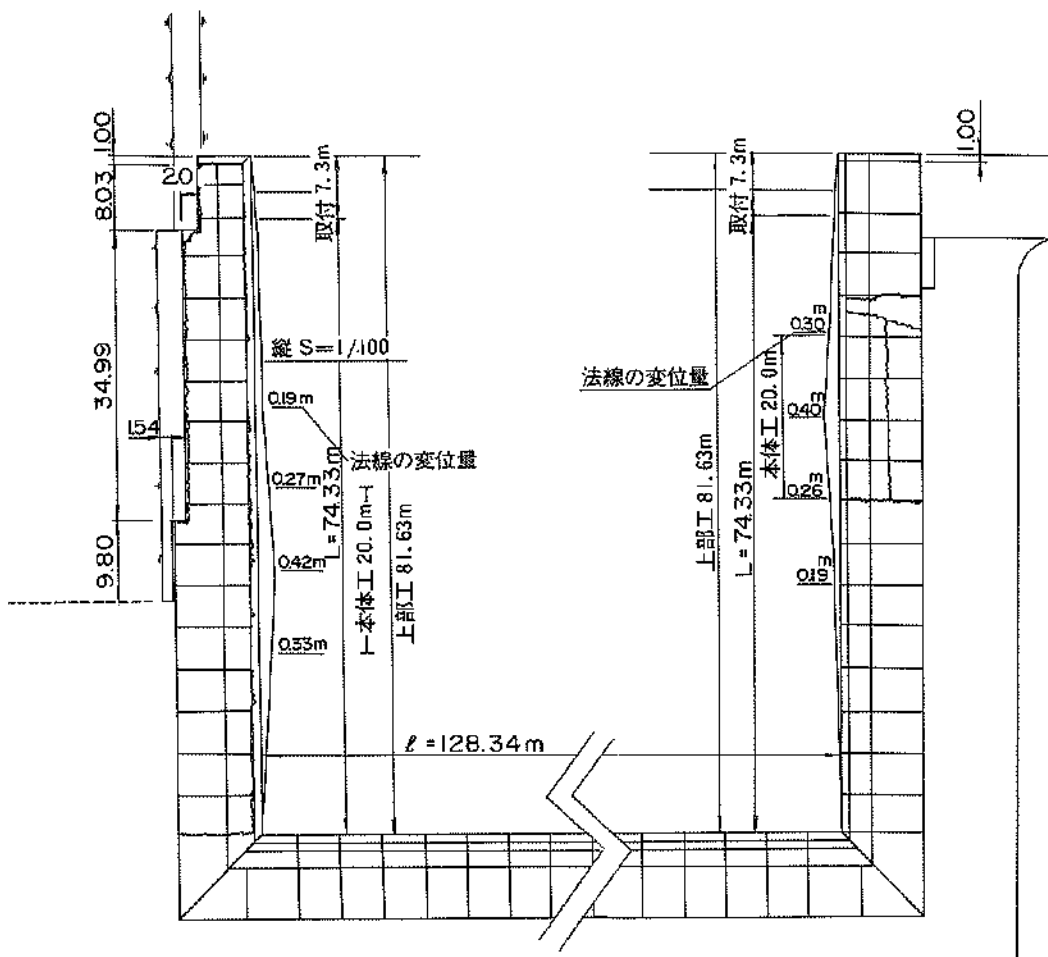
被災状況平面図 (霧多布港：⑩物揚場(-3.0m))
